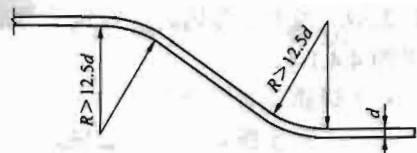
弯起钢筋弯折圆弧内半径示意图
